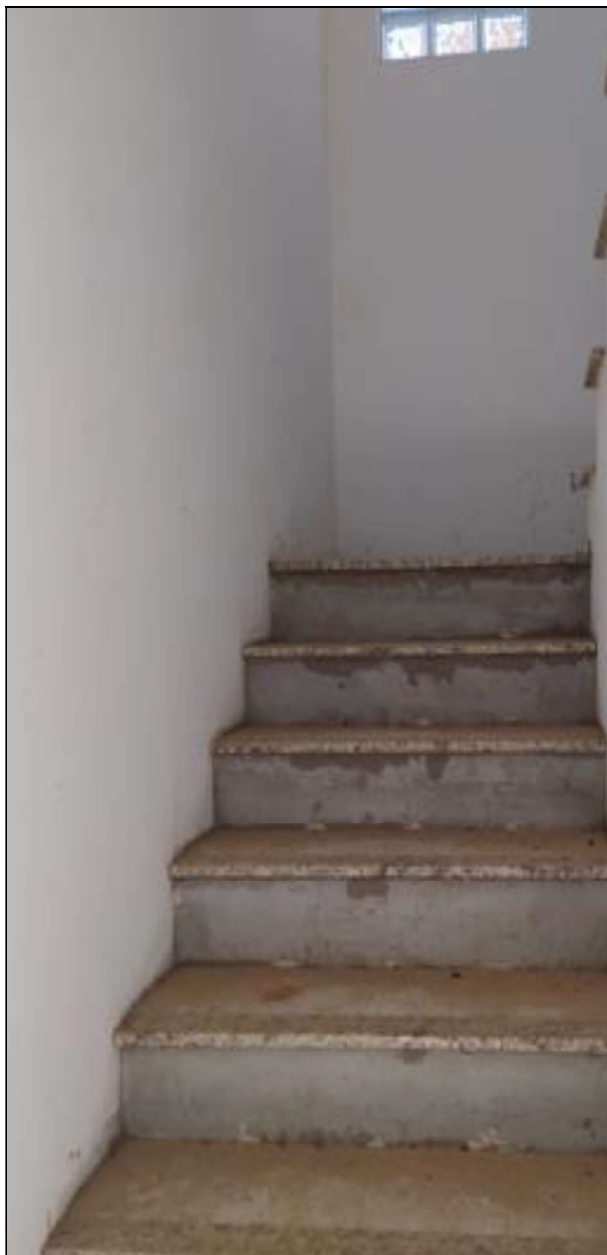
VISTA PARCIAL DA FUTURA ÁREA DE LAZER DO CONDOMÍNIO.
